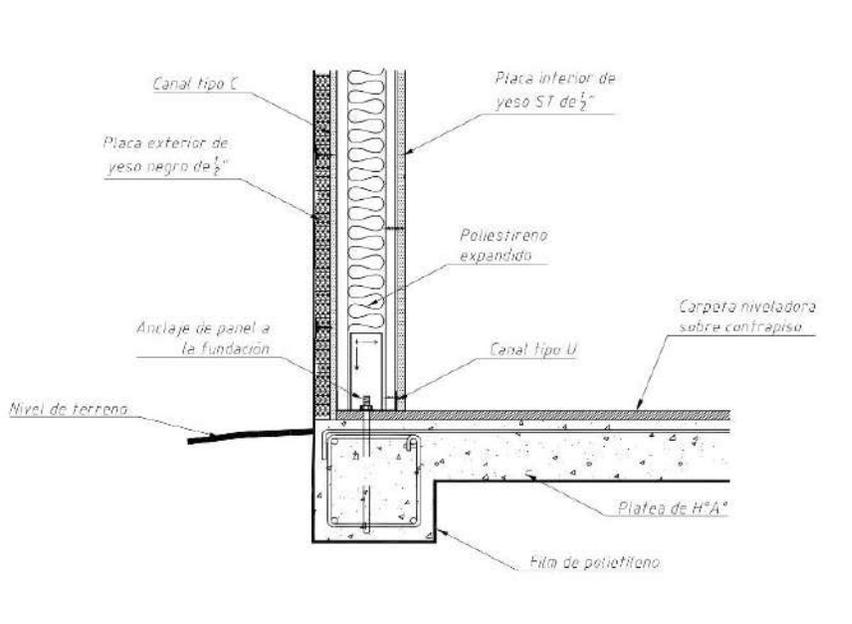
Detalle del anclaje del panel estructural a la losa o platea de cimentación. Fuente: Propia.
